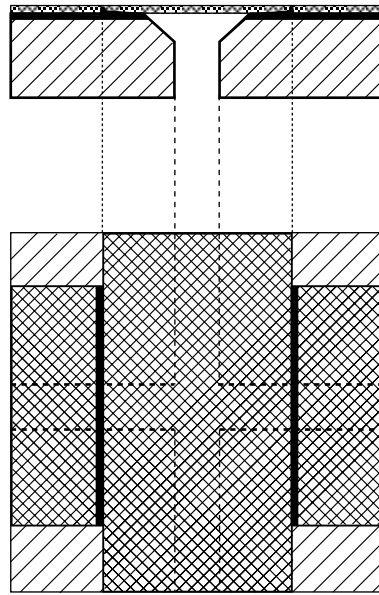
Beispiel für die Ausführung der Brandanschlüsse im Bereich Fugenkreuz
